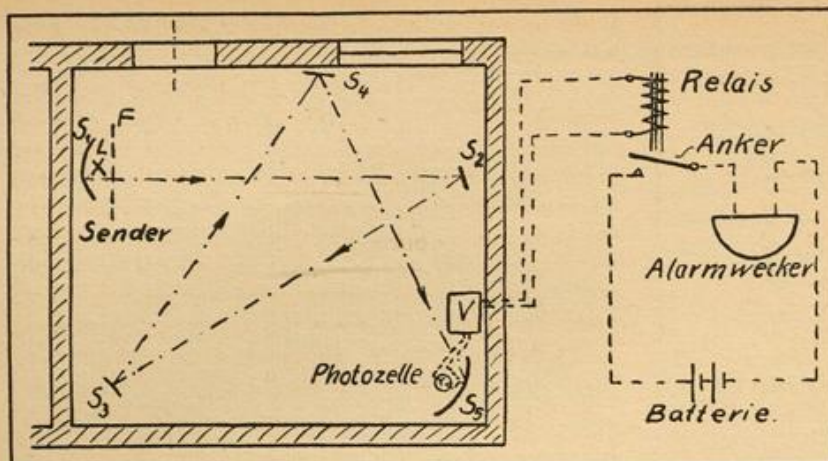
Grundrissfizzze zu einer lichtelektrischen Einbruchsicherung.
